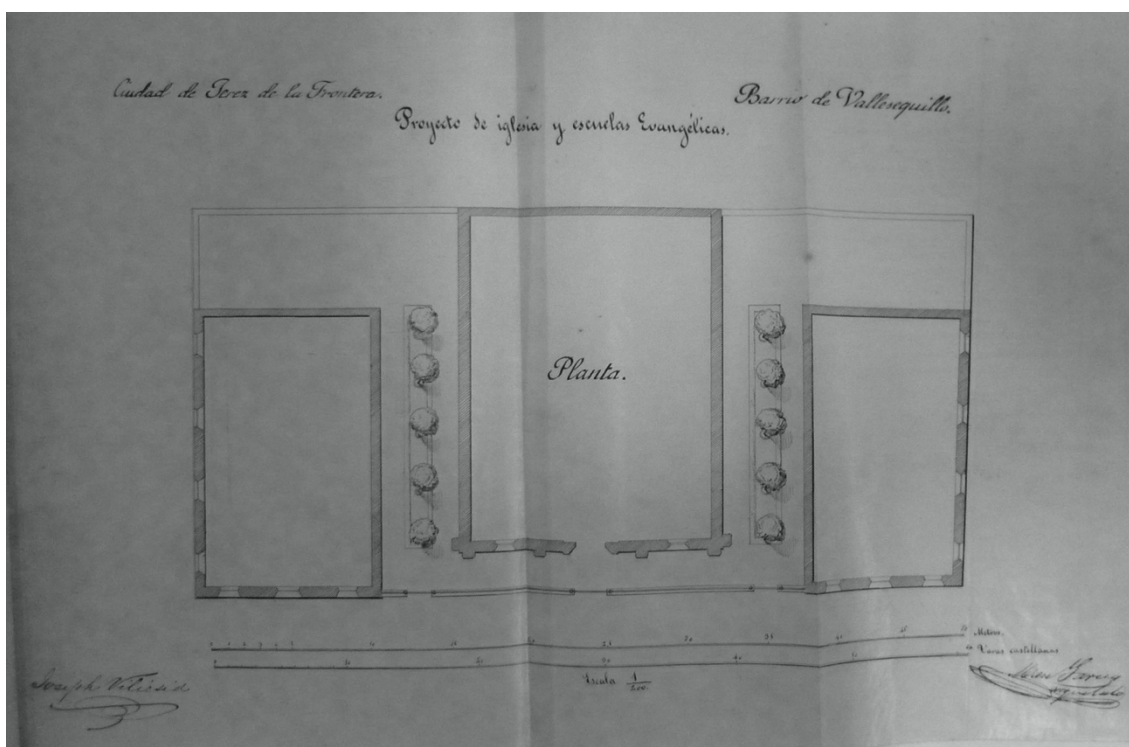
Planta de la Iglesia Protestante. Fuente: AMJF.
